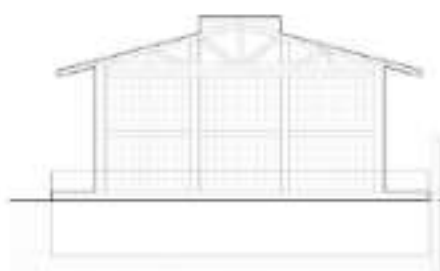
Elewacja boczna (źródło: opracowanie własne)
